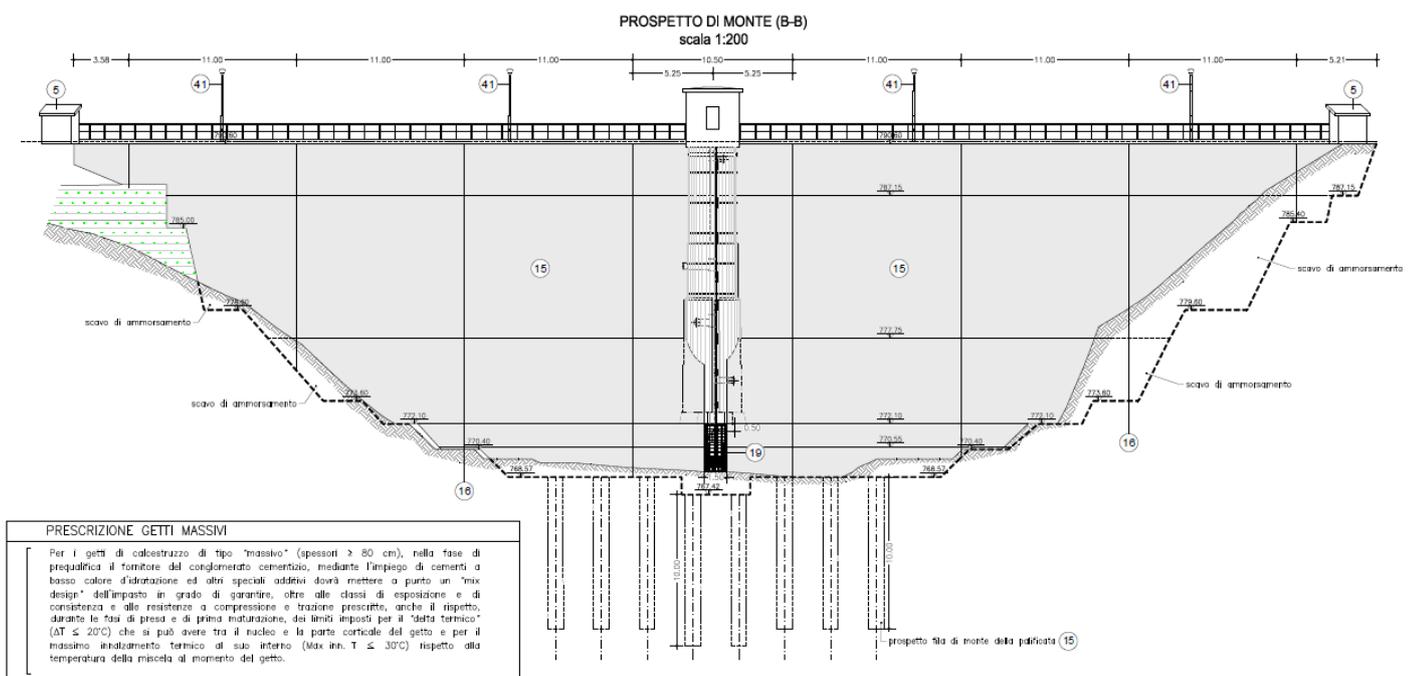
prospetto del paramento di monte nello stato di progetto.
